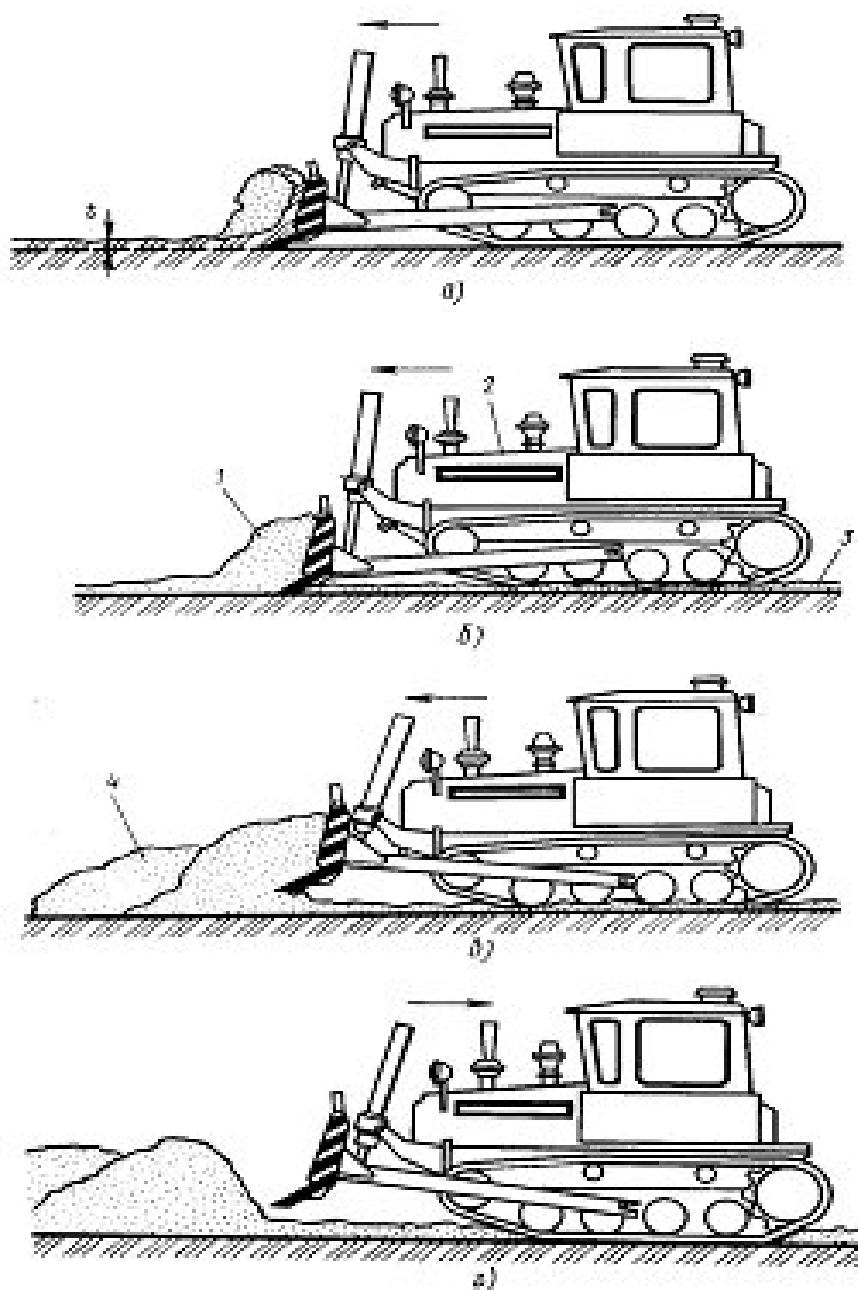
Рабочие циклы работы бульдозера при разработке и перемещении грунта: *а* – резание грунта; *б* – транспортирование с подрезанием грунта; *в* – отсыпка грунта; *г* – обратный (холостой) ход; *1* – призма грунта; *2* – бульдозер; *3* – боковой валик;
